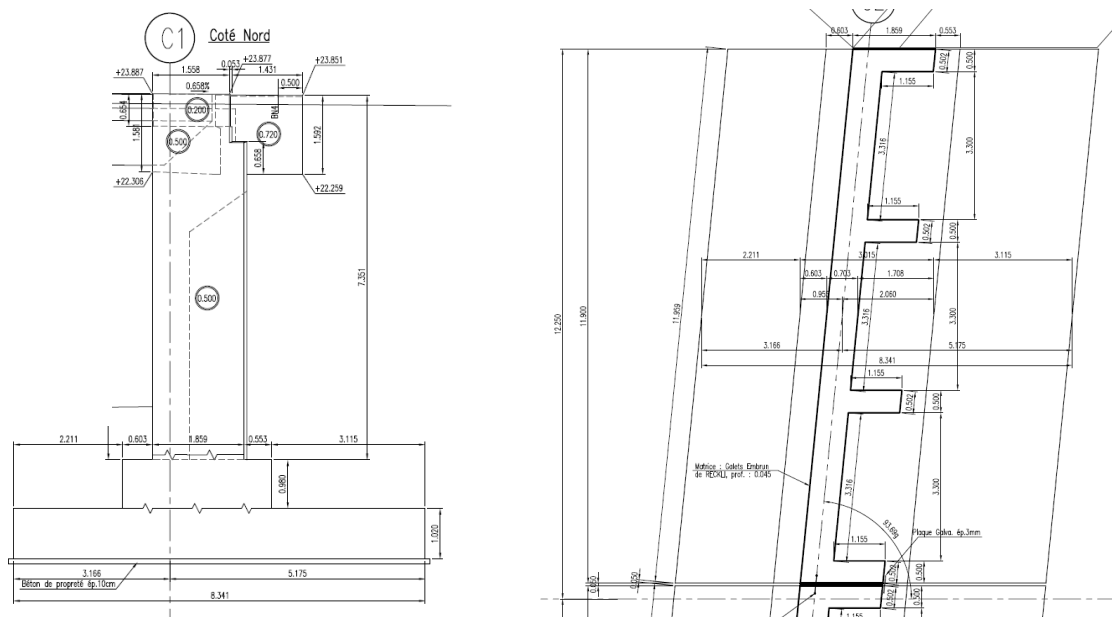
Elévation latérale et vue en plan d'une demi-culée de l'OA19
